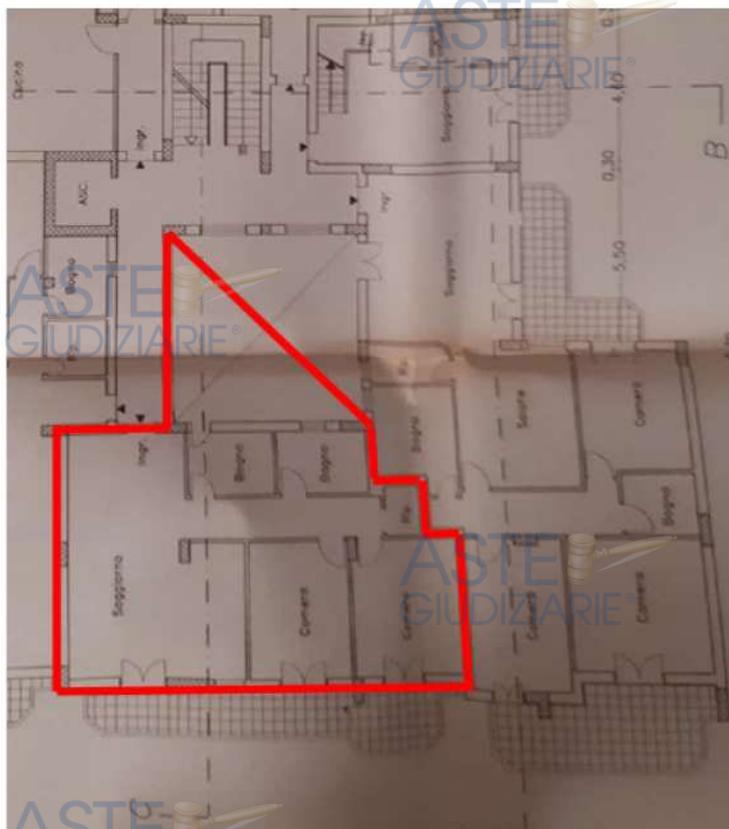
Planimetria - Stato di autorizzato (mediante polilinea di colore rosso è stato evidenziato il perimetro dell'u.i.u. oggetto di pignoramento)
